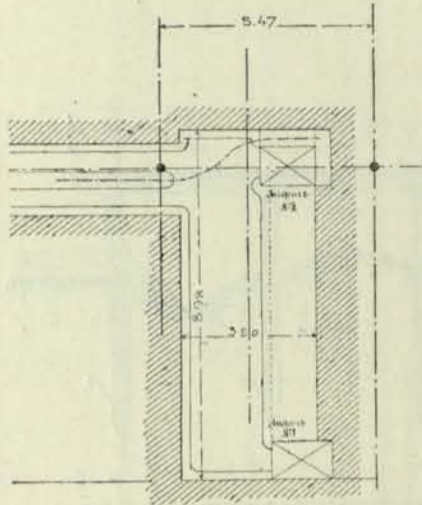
Планъ продольнаго багажнаго тоннеля.
